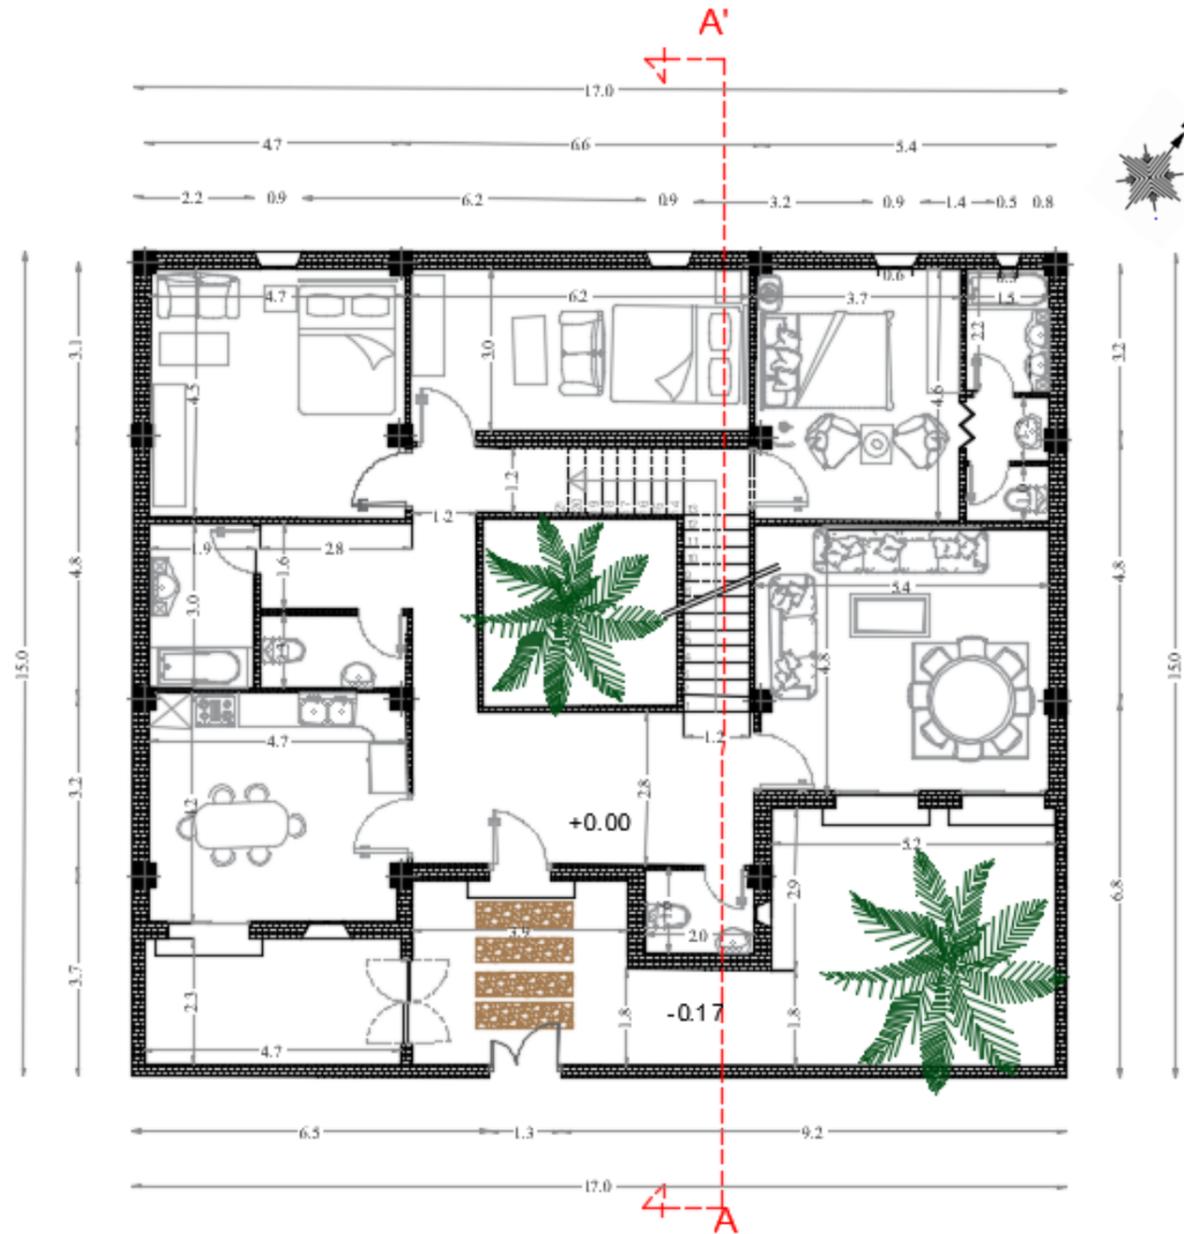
PLAN RDC LOGEMENT TYPE1;
